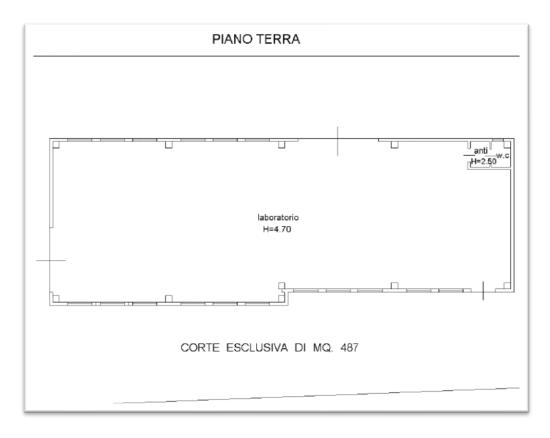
c: Planimetria catastale Mappale 1395, sub 3
